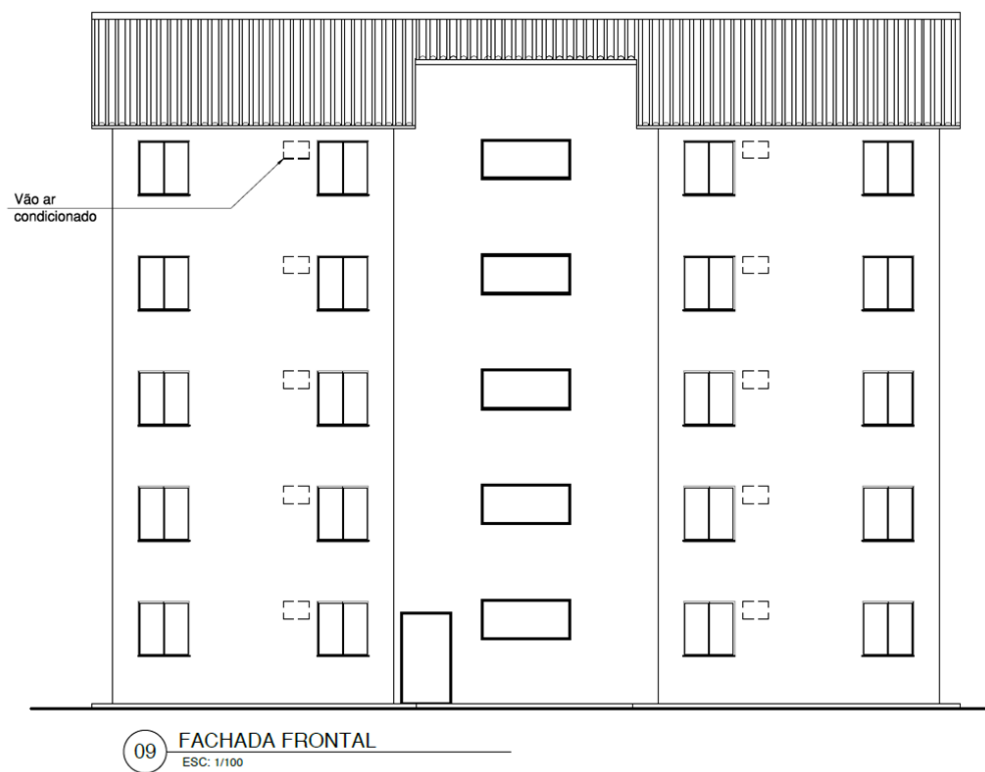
Fachada Fonte: GUILLÉN, 2013.
